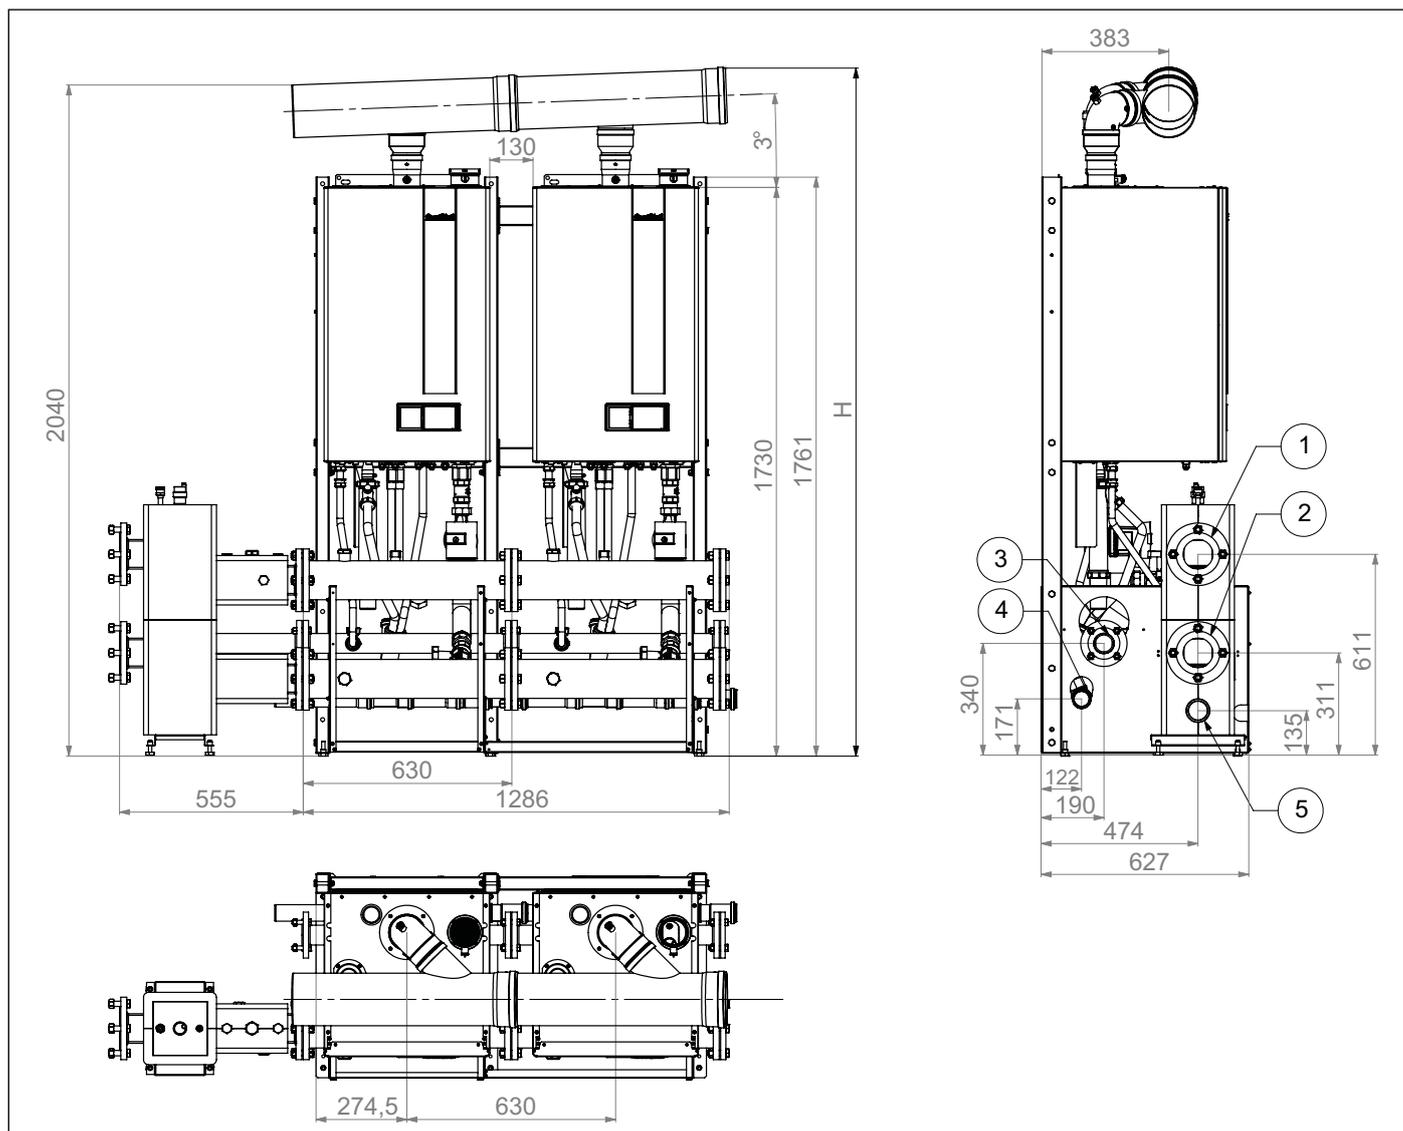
Combinación 45-60 separador hidráulico izquierdo
